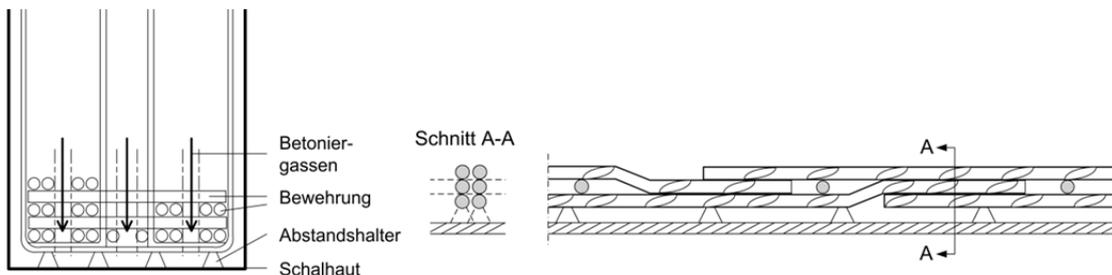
Gute Bewehrungsverlegeanweisung im Bewehrungsplan bei sehr dichter Bewehrung
